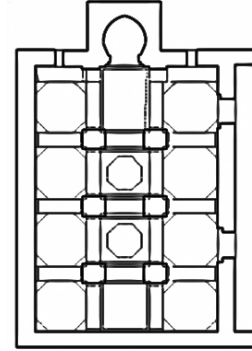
مسقط أفقي لمسجد مناراني الجامع/كينيا
